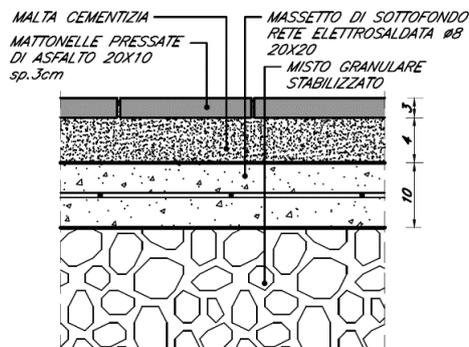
Dettaglio pacchetto H14 e schema di posa
